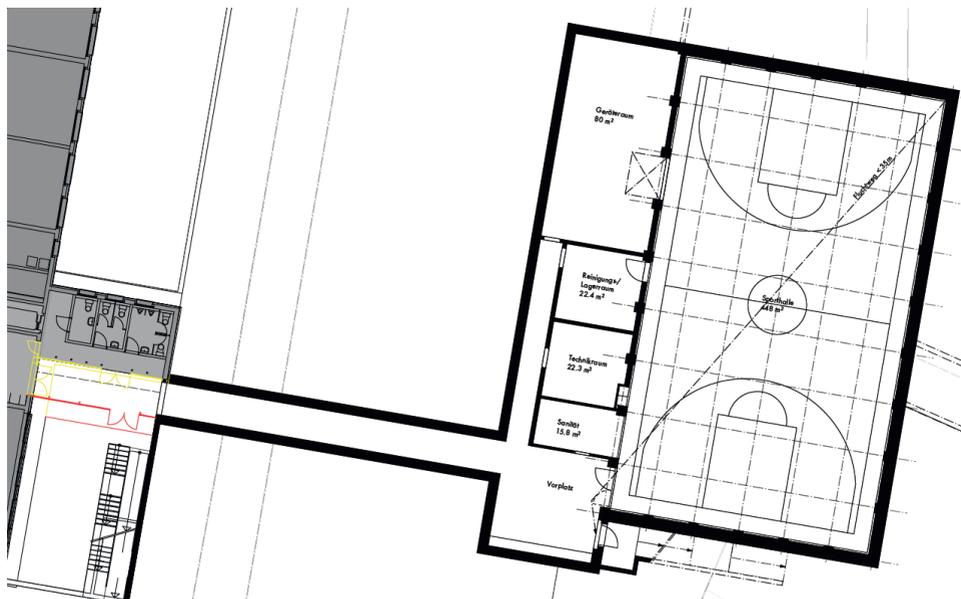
Grundrissplan Einfachsporthalle mit Verbindungsgang zum Schulhaus Zwingert
